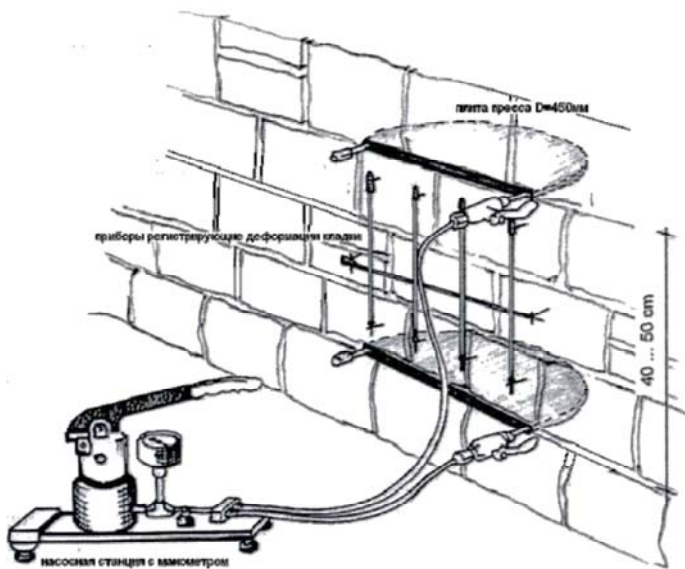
Схема испытания образцов кладки методом «Flat-Jack-Tests»
